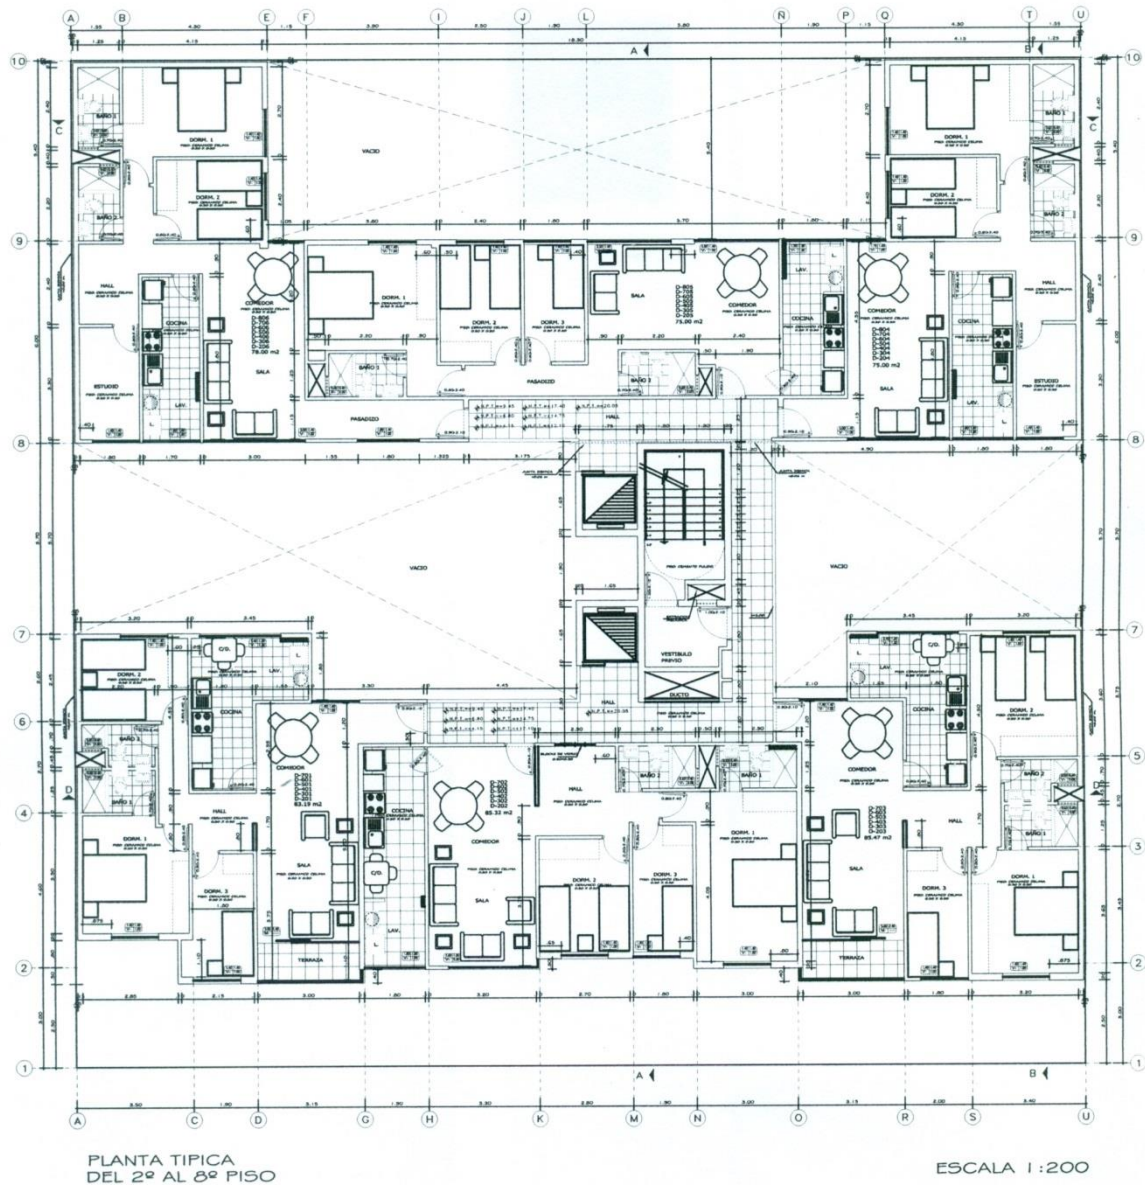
Plano de planta del segundo al octavo piso del proyecto Edificio Asturias
